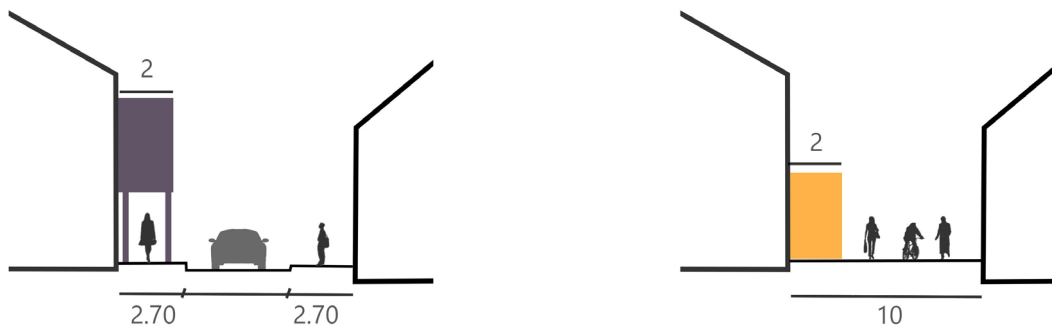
Hiérarchisation des voies : voies piétonnes désimperméabilisées mais chaussée conservée (schéma de gauche) et voie totalement désimperméabilisée (schéma de droite)
